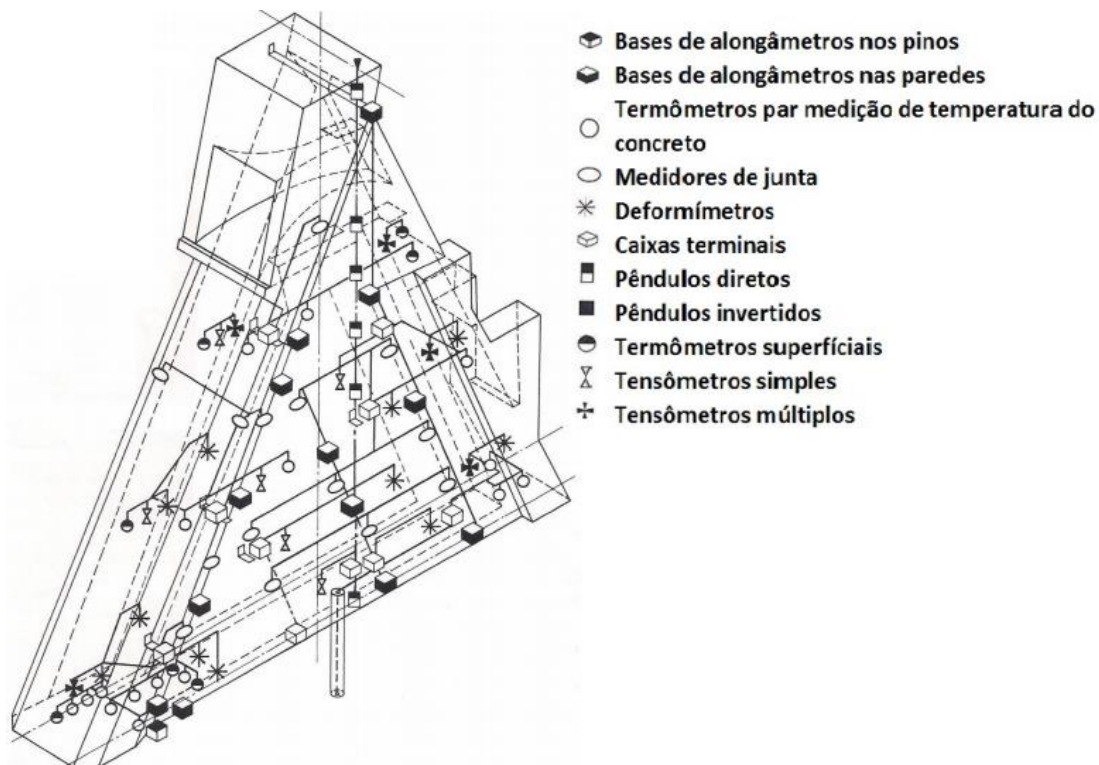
Instrumentos instalados em Bloco de Concreto. Fonte: Binacional (2003)
